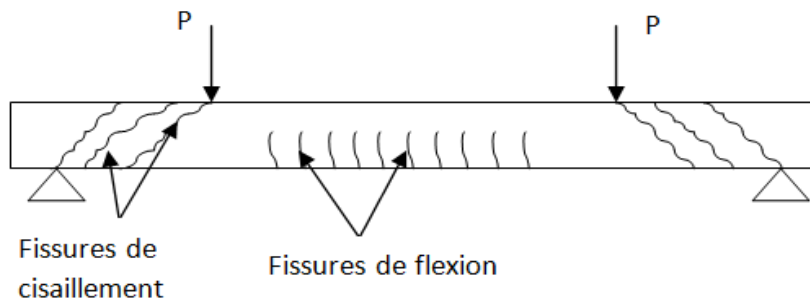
Schématisation d'une poutre fissurée soumise à deux charges concentrées.
